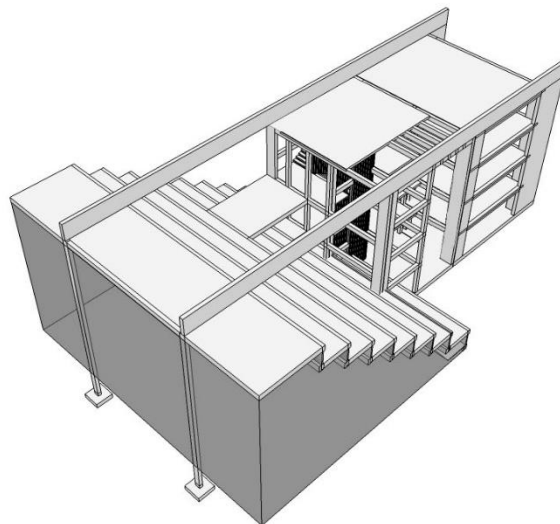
Detalle de llegada del pórtico a muro de contención. (Elaborado por: Jaire Cagigal)
